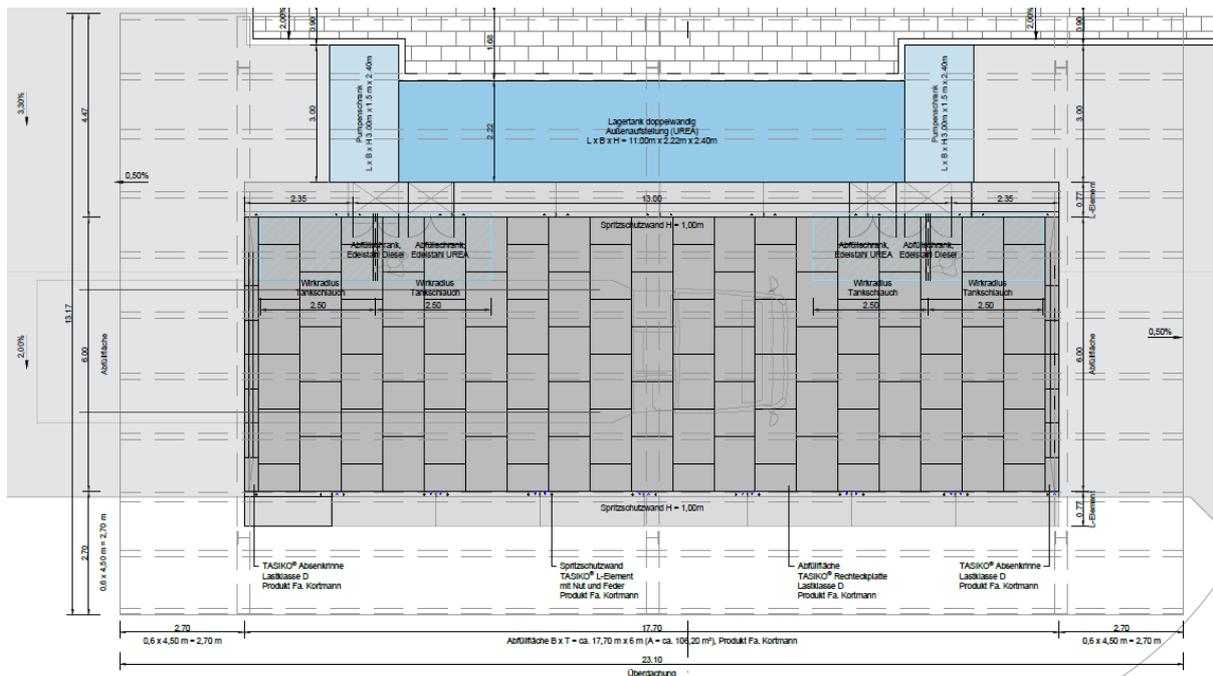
Abfüllfläche Grundriss
